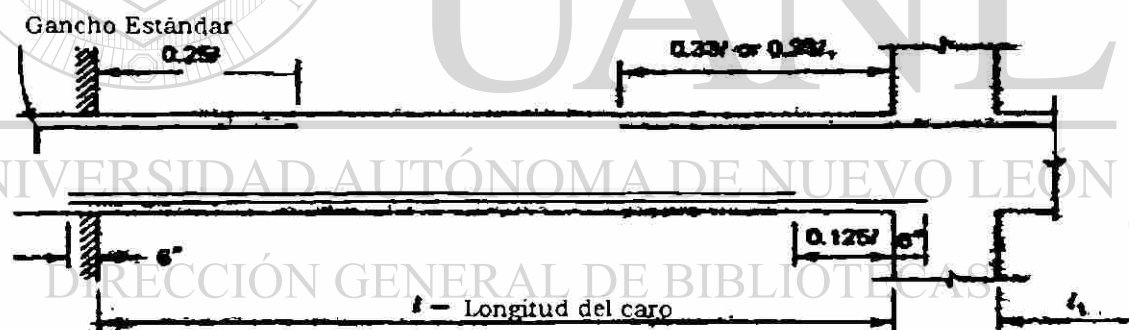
Detalle simplificado del refuerzo en vigas de mampostería.
